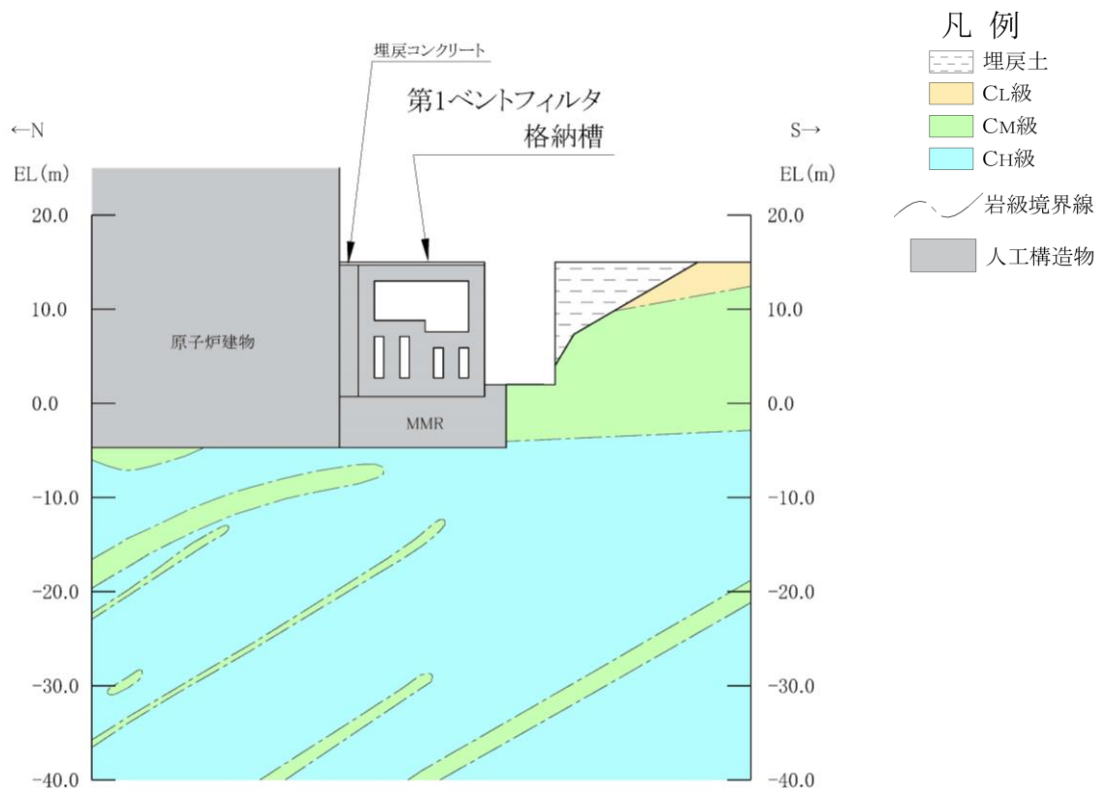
第 1 ベントフィルタ格納槽 評価対象断面図 (B-B断面位置)
